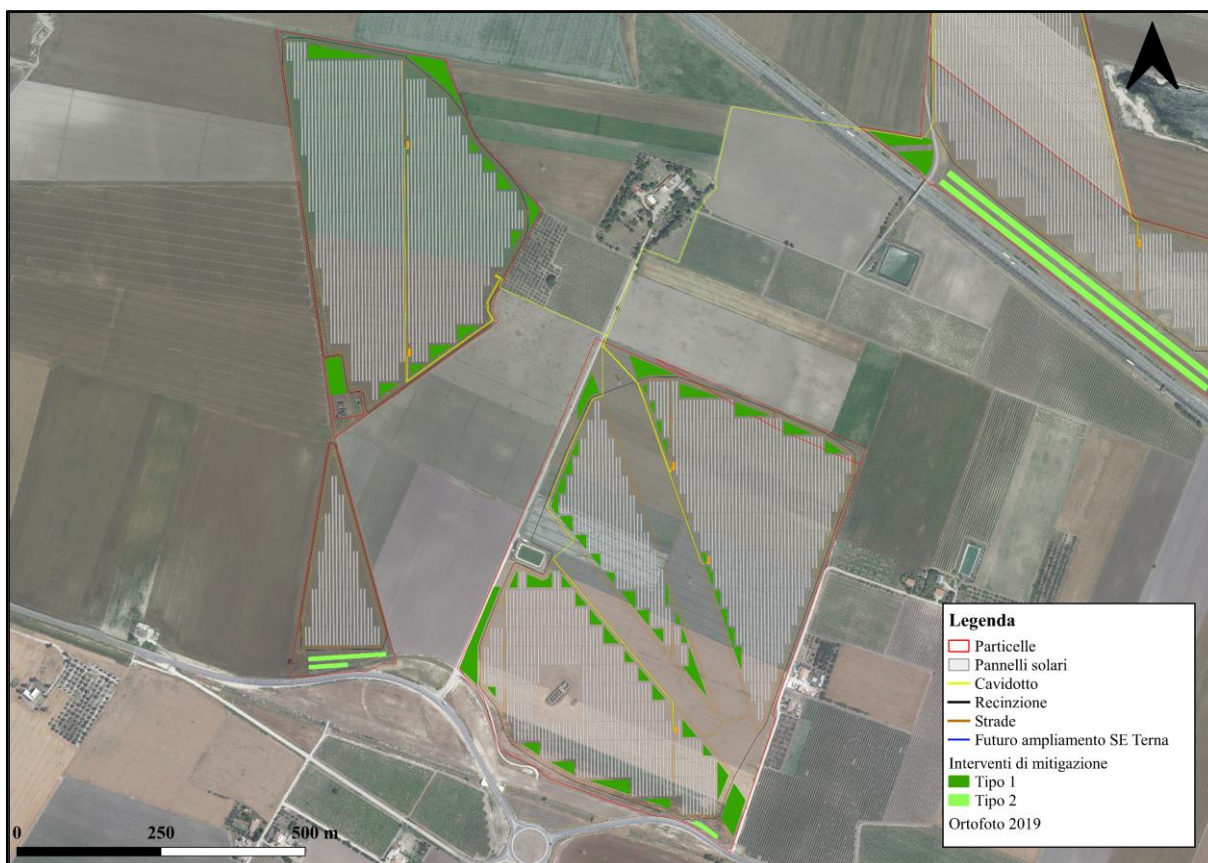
Interventi di mitigazione previsti nell'area di progetto
